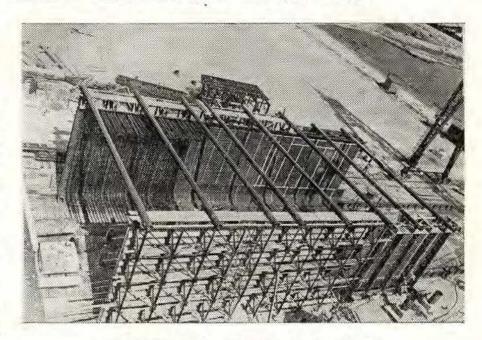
Монтаж мсталлонзоляции и внутренией инвентарной опалубки токнепьной секции.
